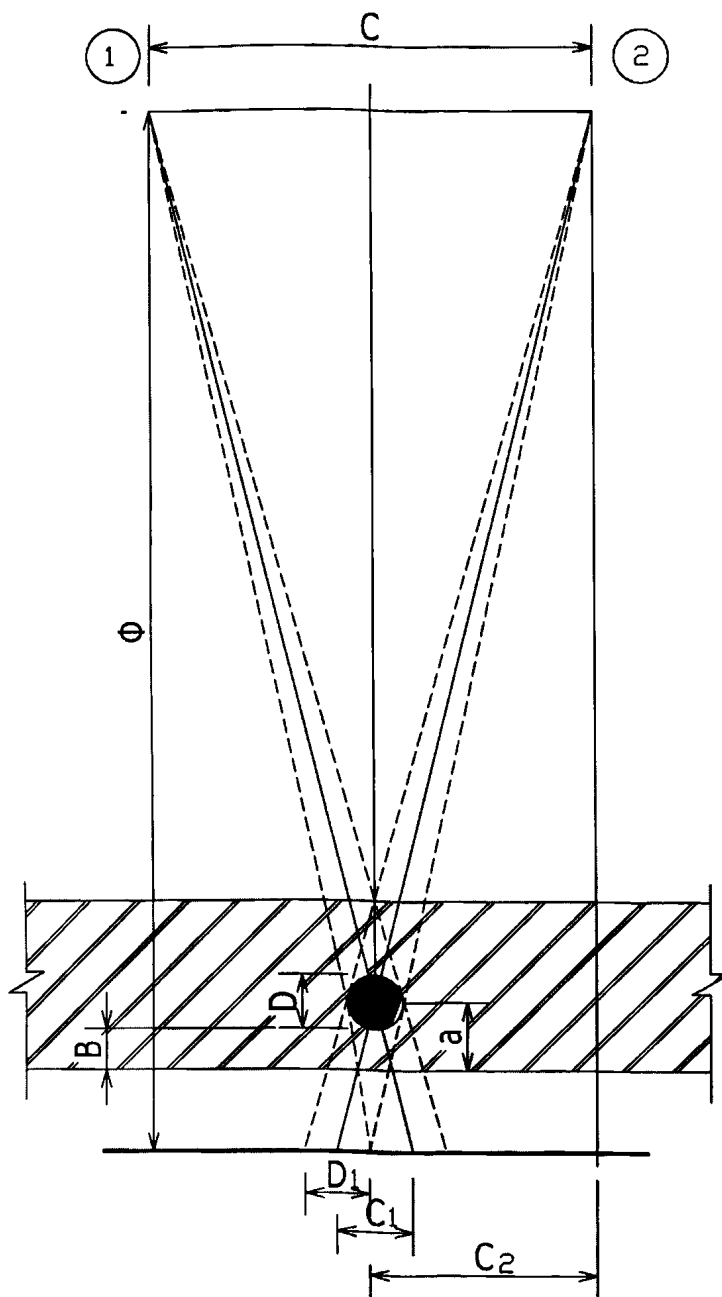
Определение диаметра и местоположения арматурного стержня в бетонной конструкции
